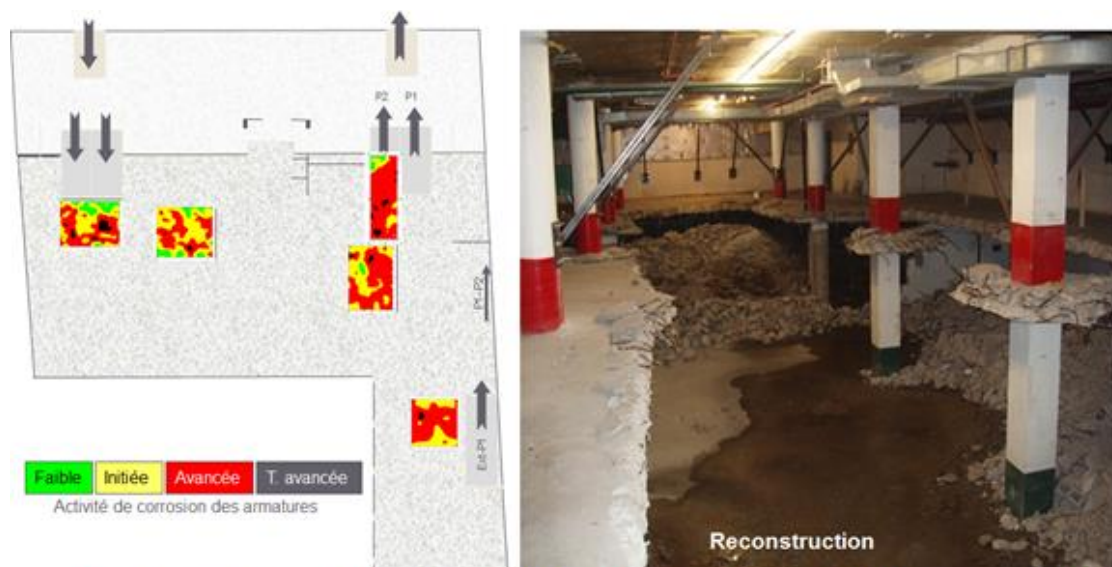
Résultat d'un relevé de potentiel de corrosion sur 5 sections (~ 4 m par 5 m) d'une dalle de stationnement. La corrosion est dans un stade avancé. Il a été jugé plus approprié de démolir la dalle existante et de la reconstruire.
